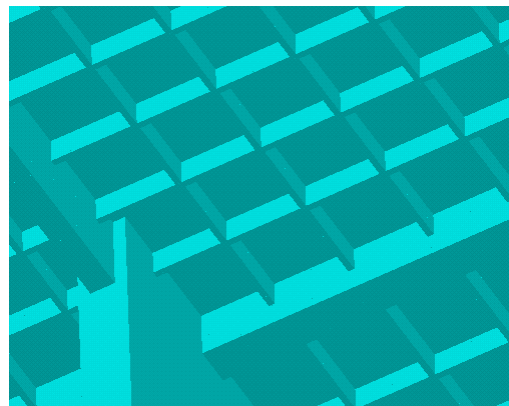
Detalhe das nervuras das lajes do modelo estrutural I.
